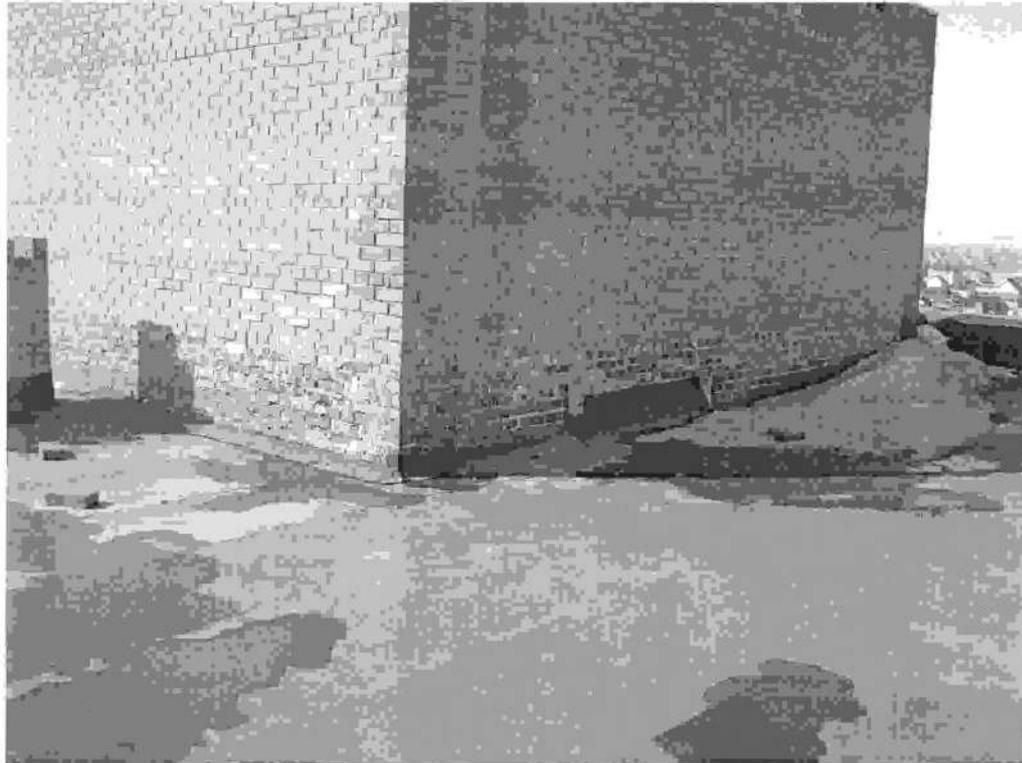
Нарушено примыкание кровли к стенам. Секция 6. Состояние на 01.04.2015г
